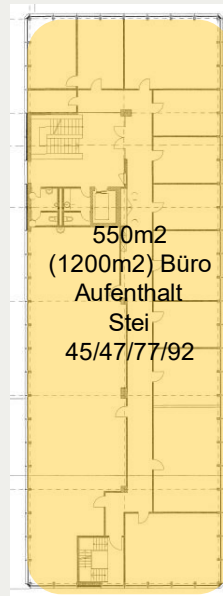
Flächendisposition Mövenstrasse 17 Gebäude Ost
